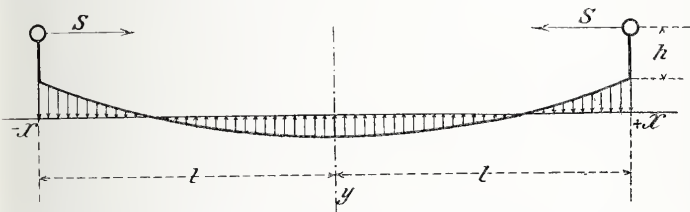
In der Querrichtung elastisch gestützter Stab mit einseitiger Längsbelastung.
